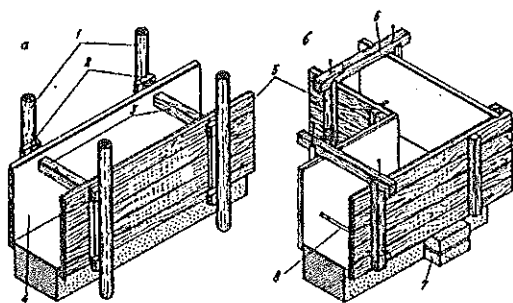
Конструкции опалубки для устройства глинобитных стен:
